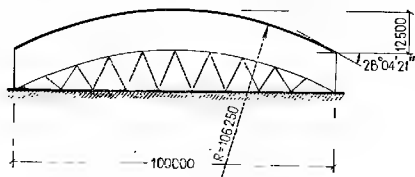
Схема сетчатой полой оболочки для перекрытия рынка (поперечный разрез)
